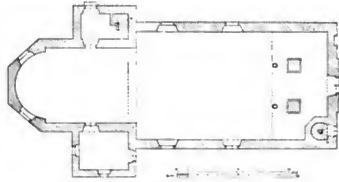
Wermützitz. Grundriss der Kirche.
